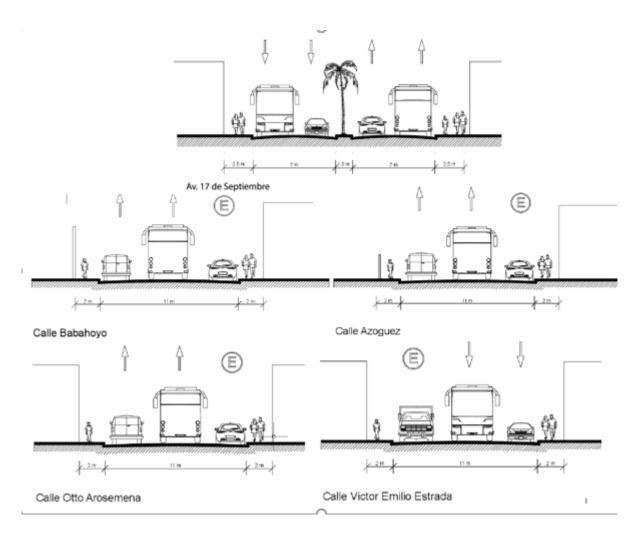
Diagrama de corte transversal de calles perimetrales al terminal terrestre Fuente: Autor
